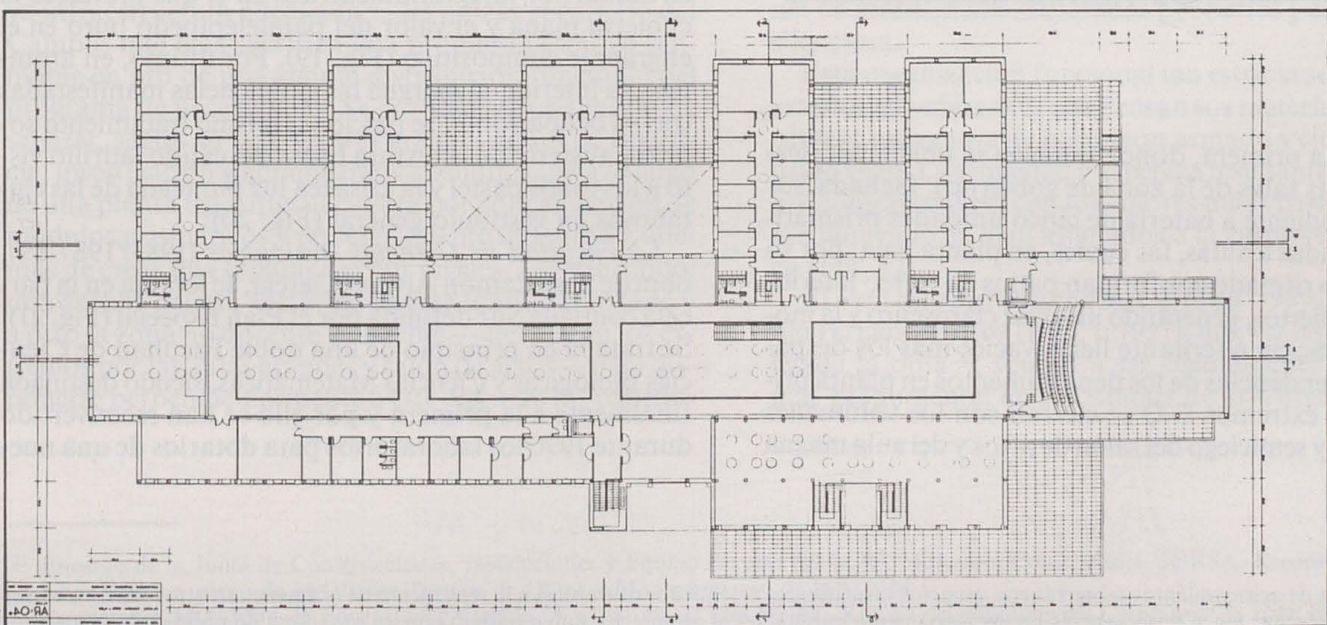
José M. García de Paredes: Facultad de Psicología. Proyecto de ejecución. Planta primera.
